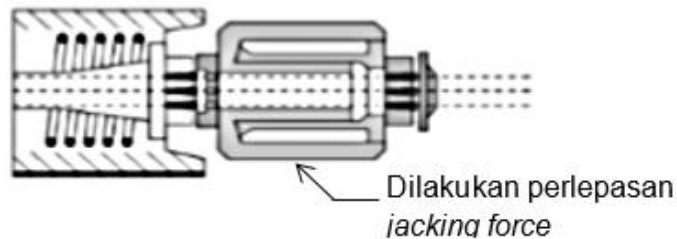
Instalasi *Stressing Jack hydraulic
